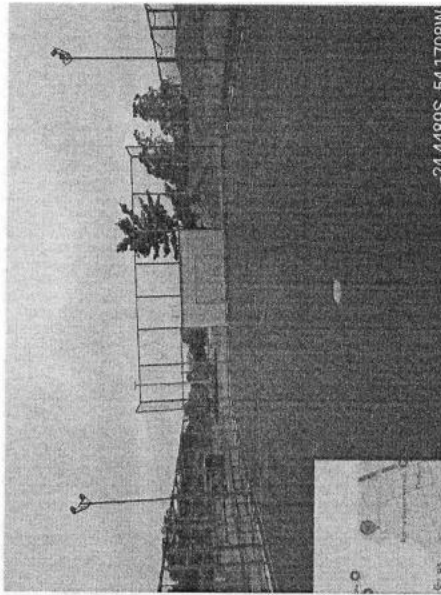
Estrutura existente da Quadra. -24,4489S -54,1708W
